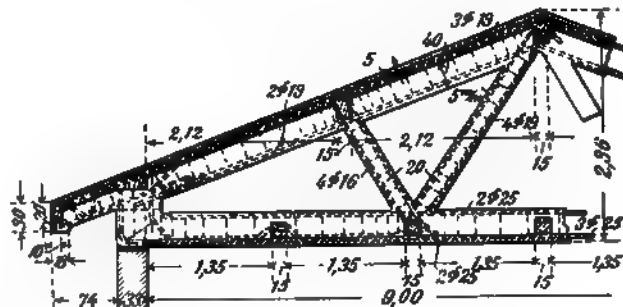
Dach auf dem Bahnhof in Atlanta.
